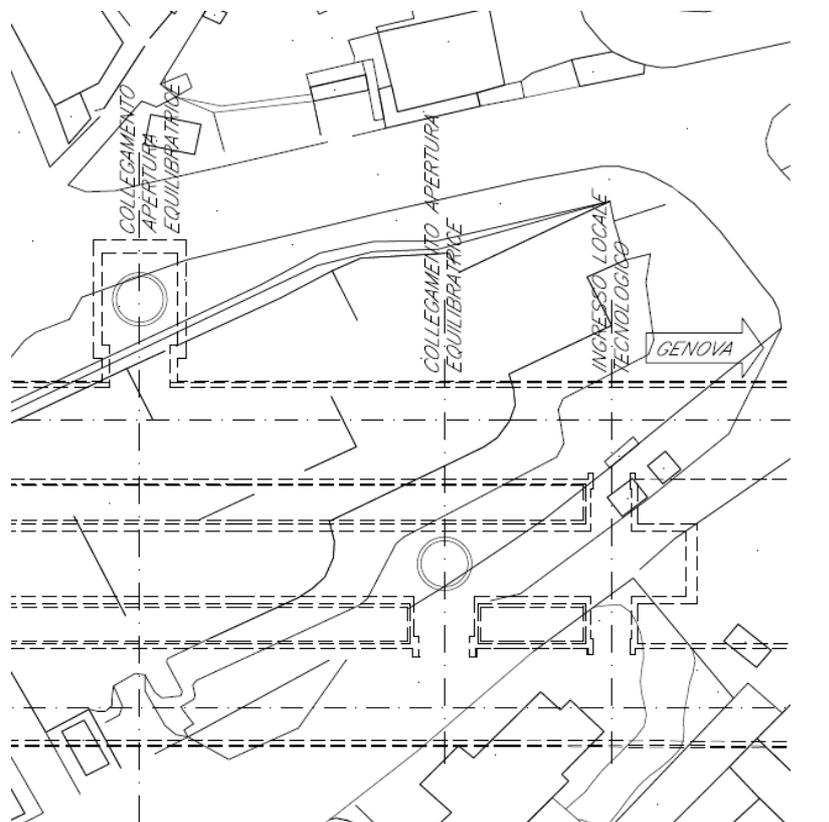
Pianta pozzi equilibratori e di ventilazione
